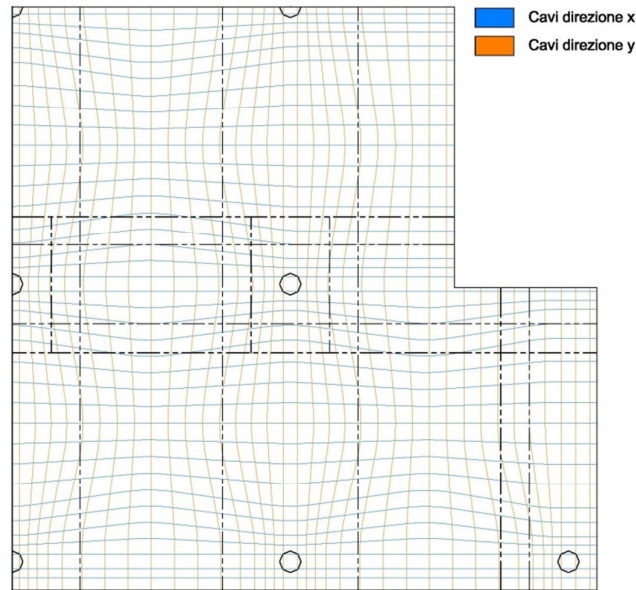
Stralcio disposizione dei cavi di precompressione
